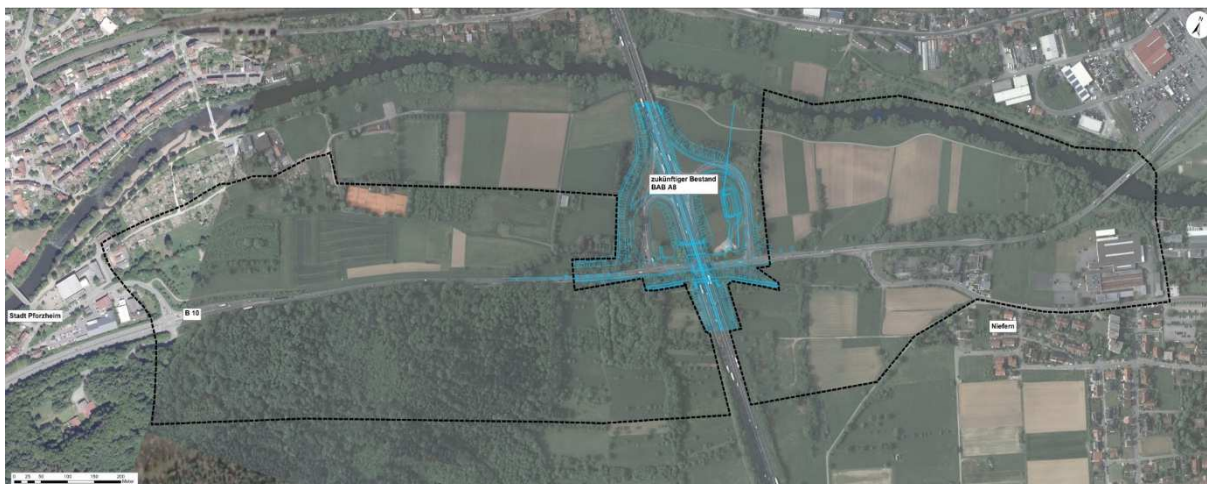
Detaillierte Abgrenzung des Untersuchungsraumes zum 4-streifigen Ausbau der B 10.
